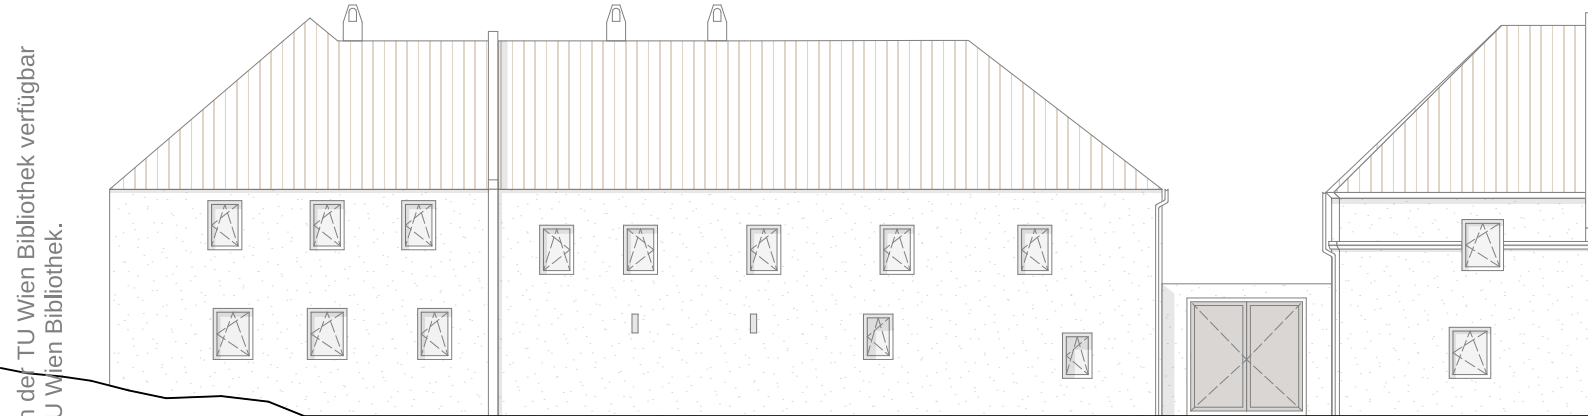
Grundrissausschnitt EG | Hofansicht | Gemeindeamt, Bibliothek, Büro, M.1:200
